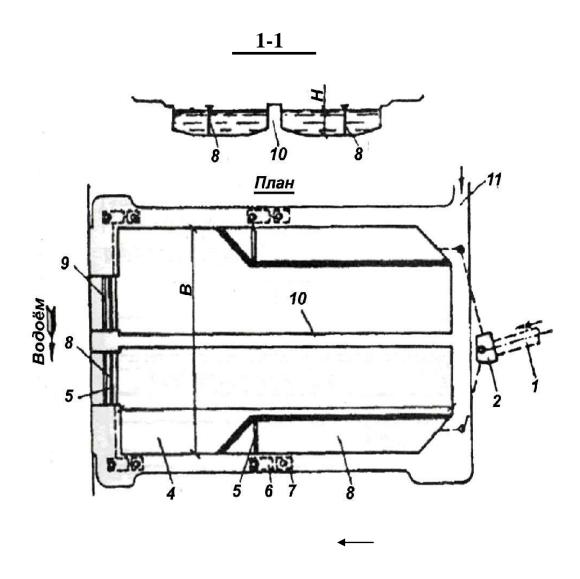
Схема пруда-отстойника на сопряжении с водоемом
